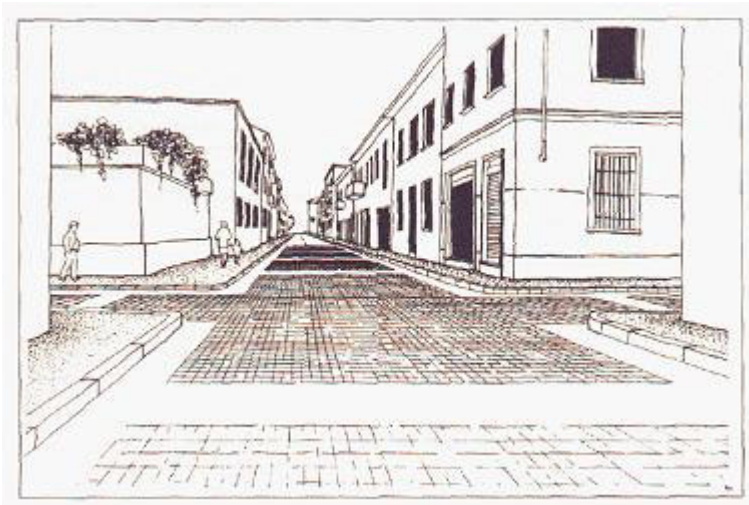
variazione di pavimentazione in corrispondenza di incrocio
